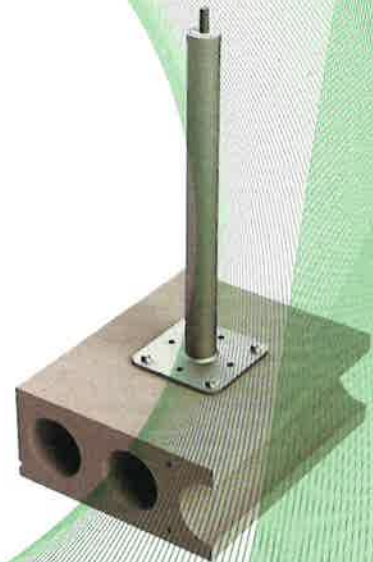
Anschlageinrichtung, Typ: SAFEX VARIANT montiert auf einer Stahlbetonhohlziele
